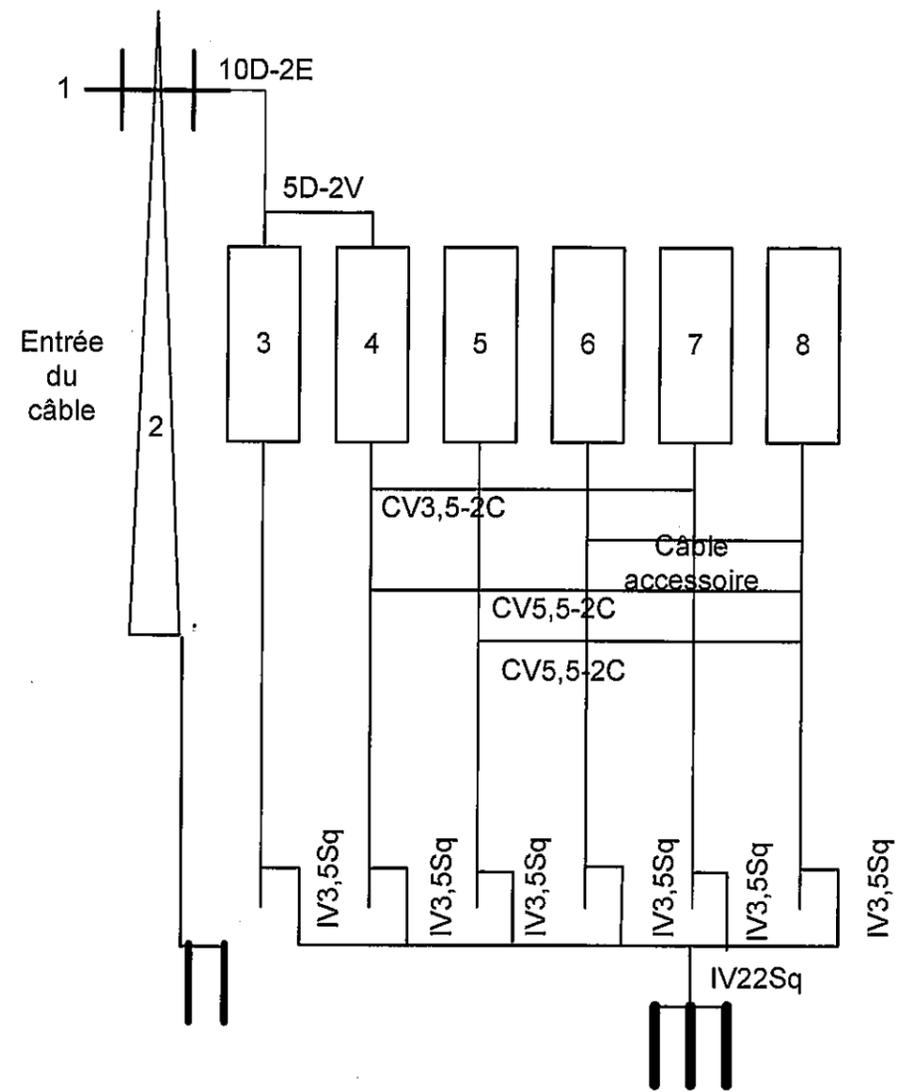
(2) PLAN DE SITUATION ET CABLAGE
